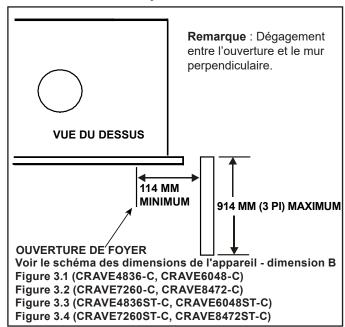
Dégagements du pied du manteau et des parois (acceptable de part et d'autre de l'ouverture)
